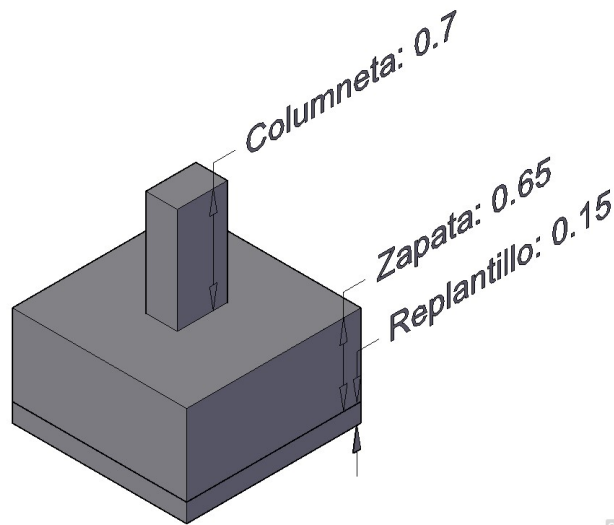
Gráfico 3D de replantillo, zapata y columneta de hormigón
